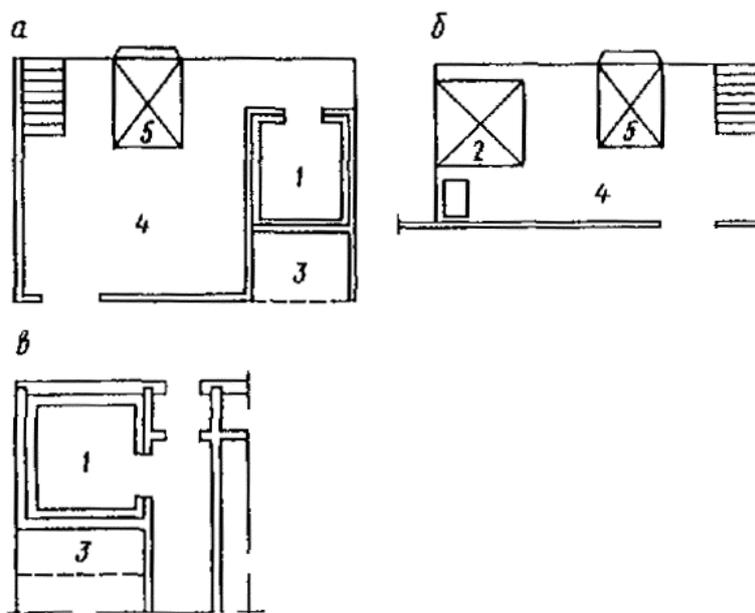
Камера пищевых отходов (а, б, в - варианты планировок)
